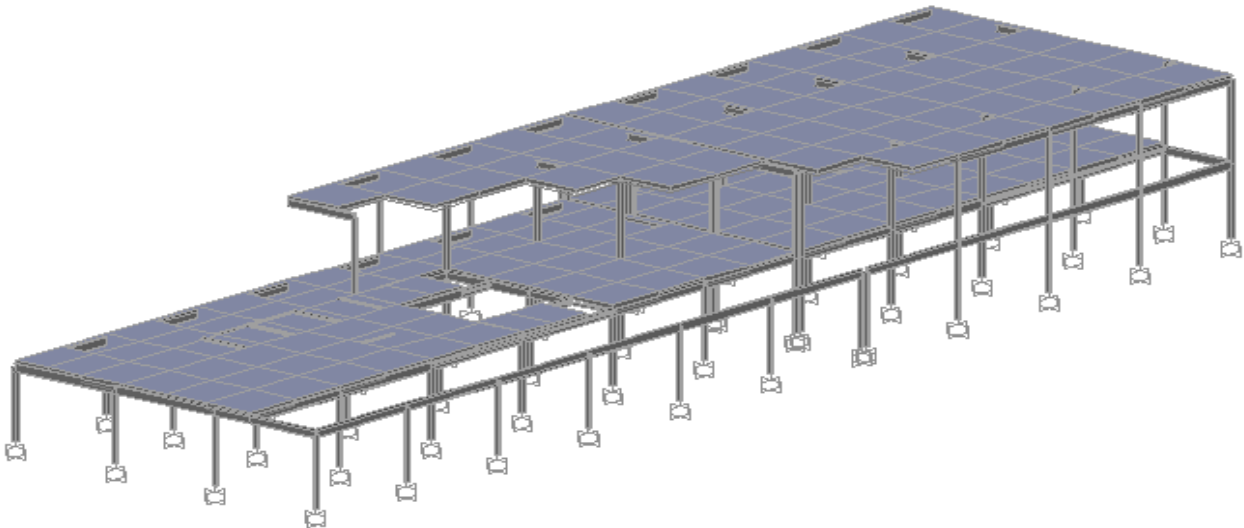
BLOQUE I – VISTA EXTRUIDA VESTÍBULO
